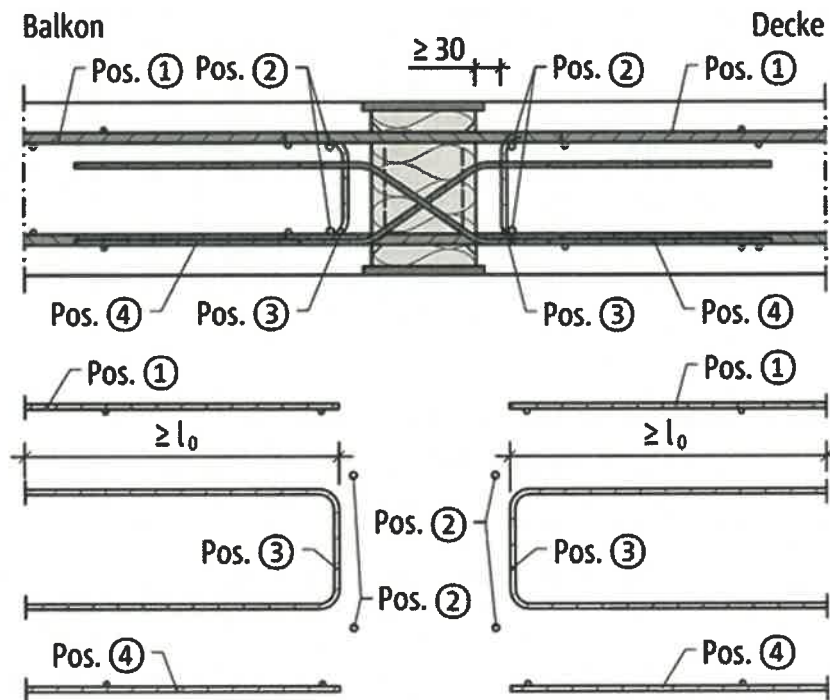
Schematische Darstellung der bauseitigen Anschlussbewehrung
